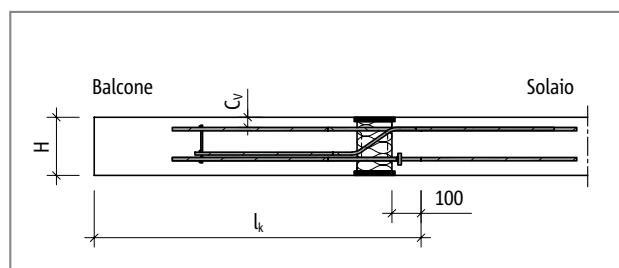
Schöck Isokorb® XT tipo CL: sistema statico
